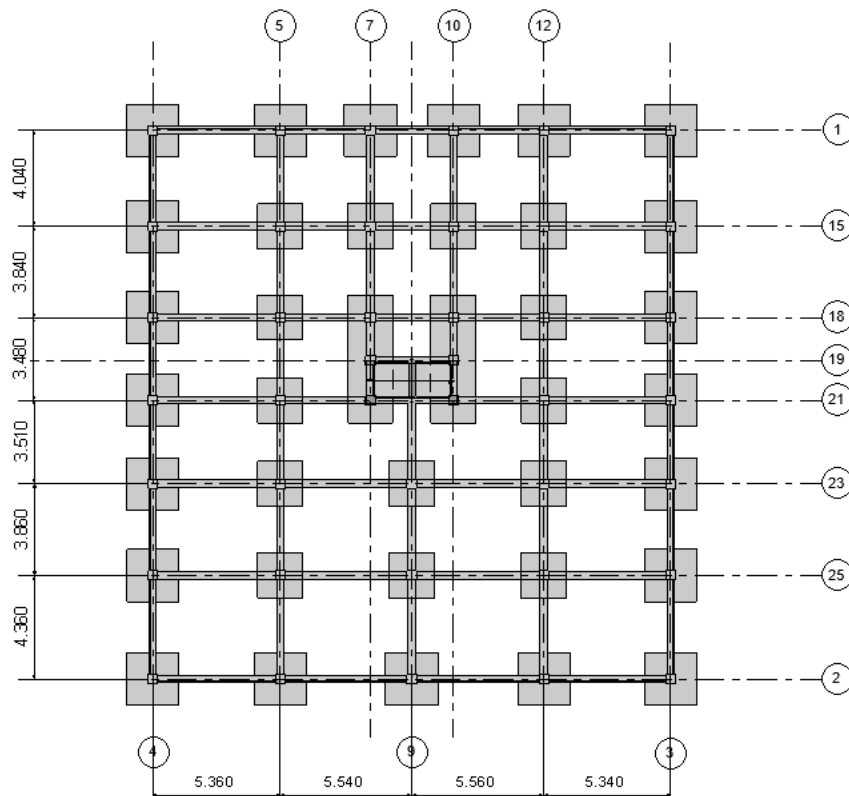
Planta estrutural da fundação de ambas as soluções (Revit).
